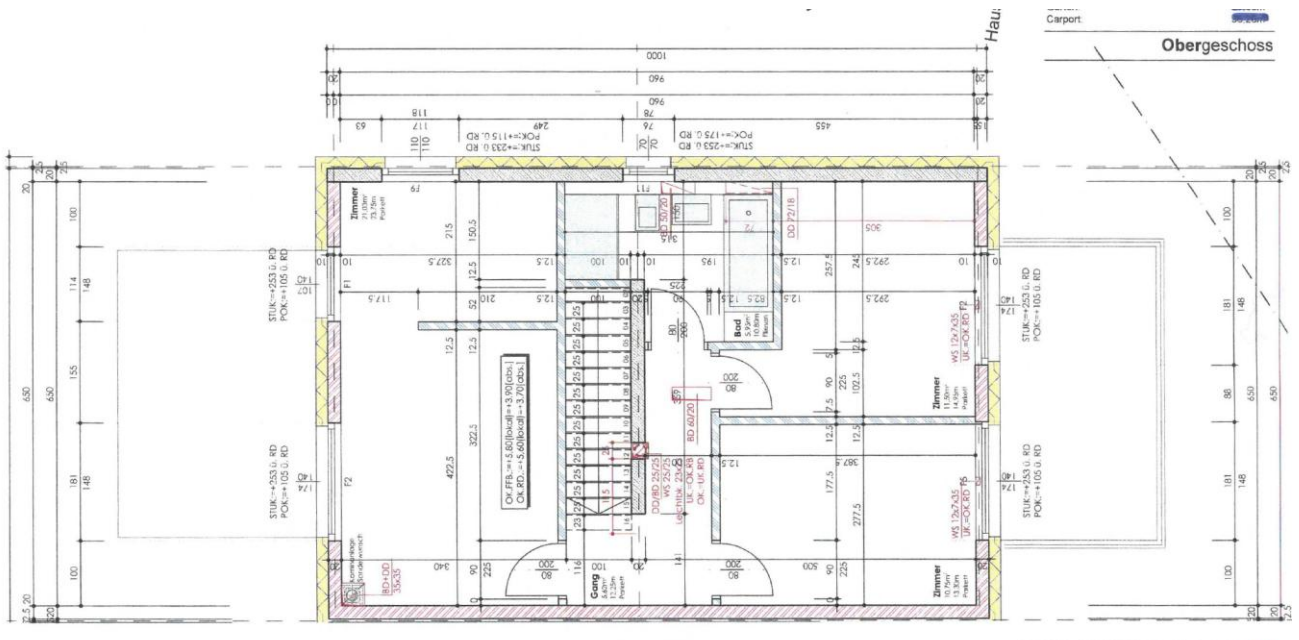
Grundriss Obergeschoss Reihenhaus Top I1 gem. Nutzwertgutachten v. 17.04.2018
